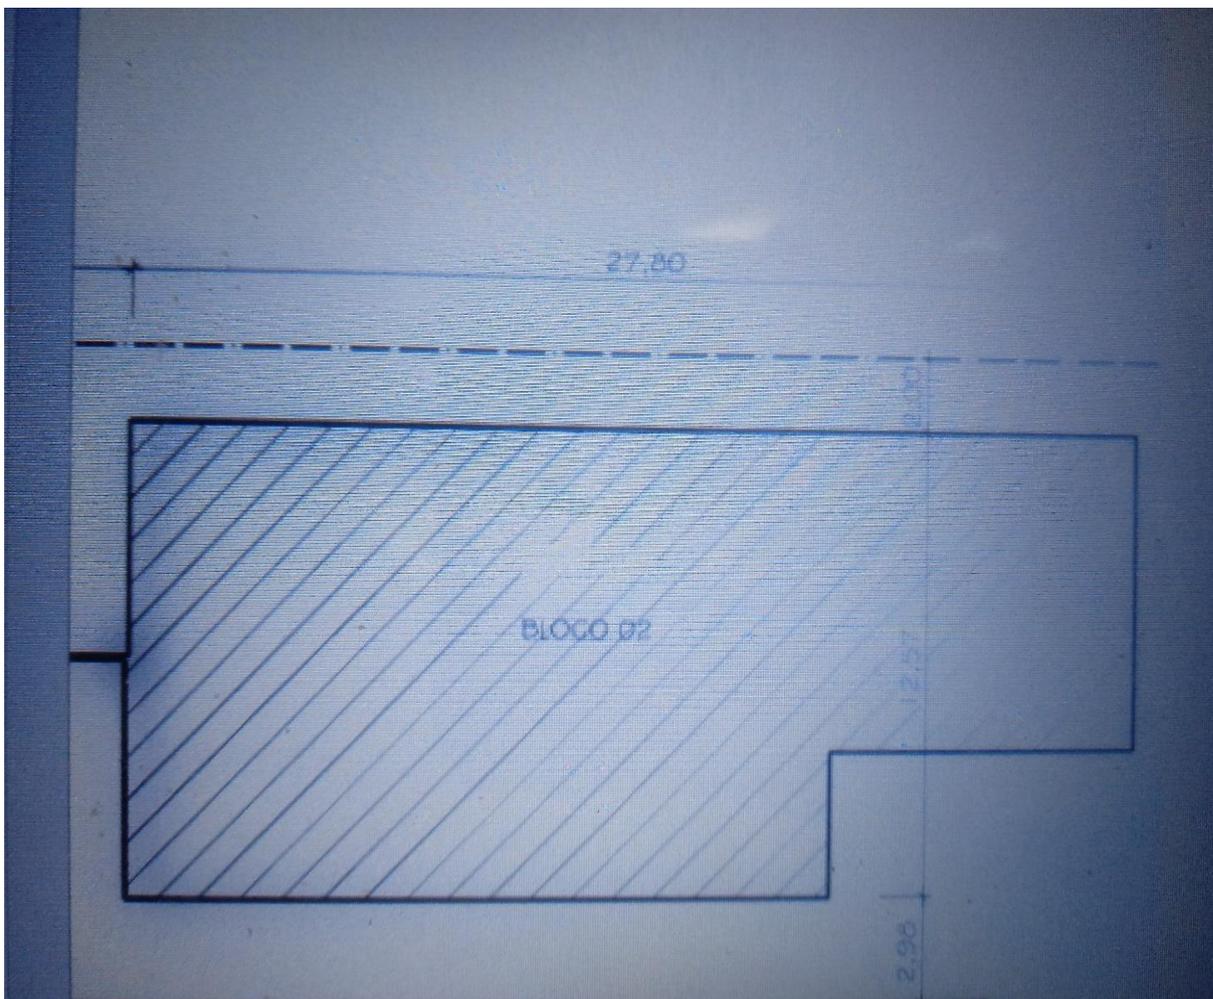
PLANTA LOCAÇÃO DA EMEF "CÓRREGO DO MILANEZ".
